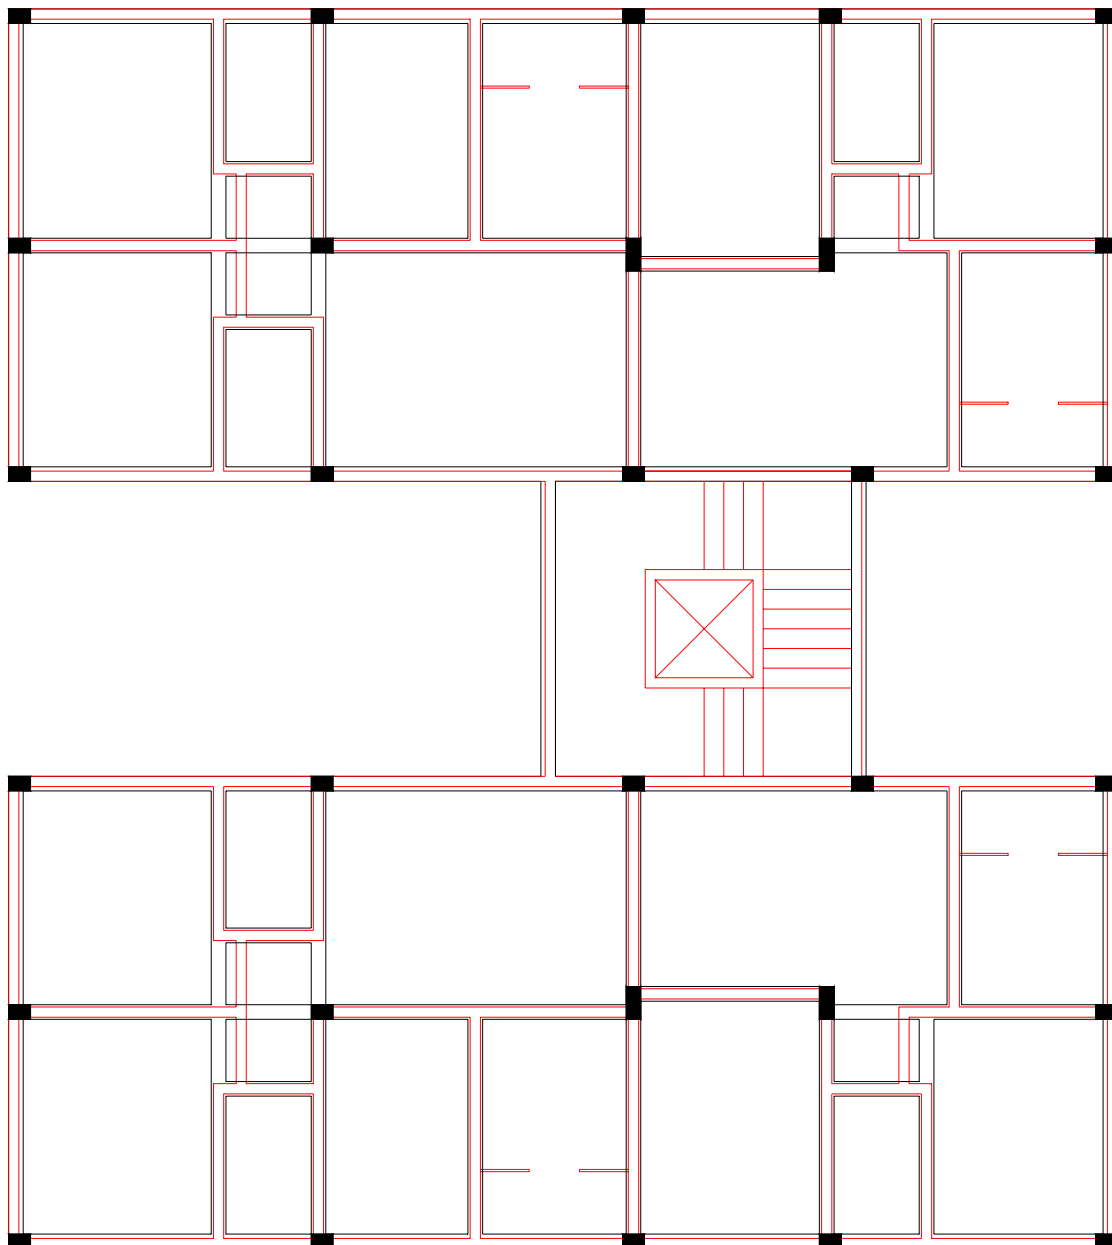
Prédio “A” – Opção 3 – Superposição das alvenarias do pavimento tipo sobre a estrutura
